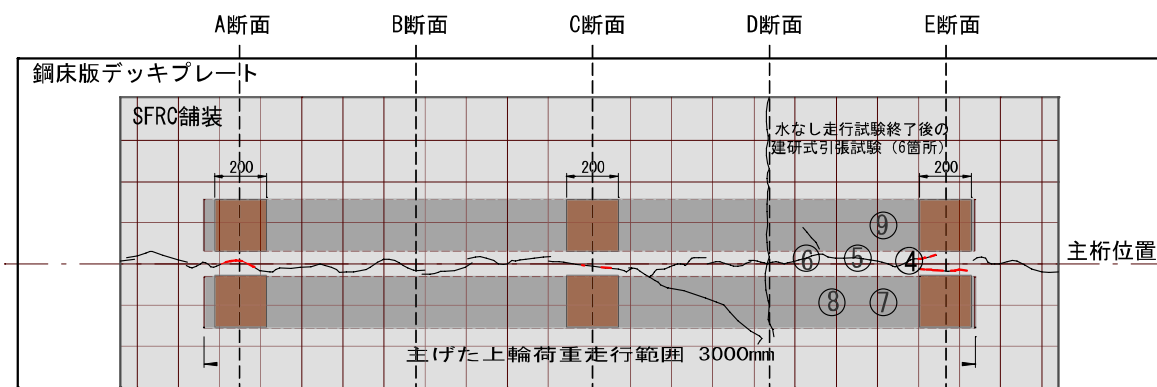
100万回輪荷重走行後のひび割れ状況
